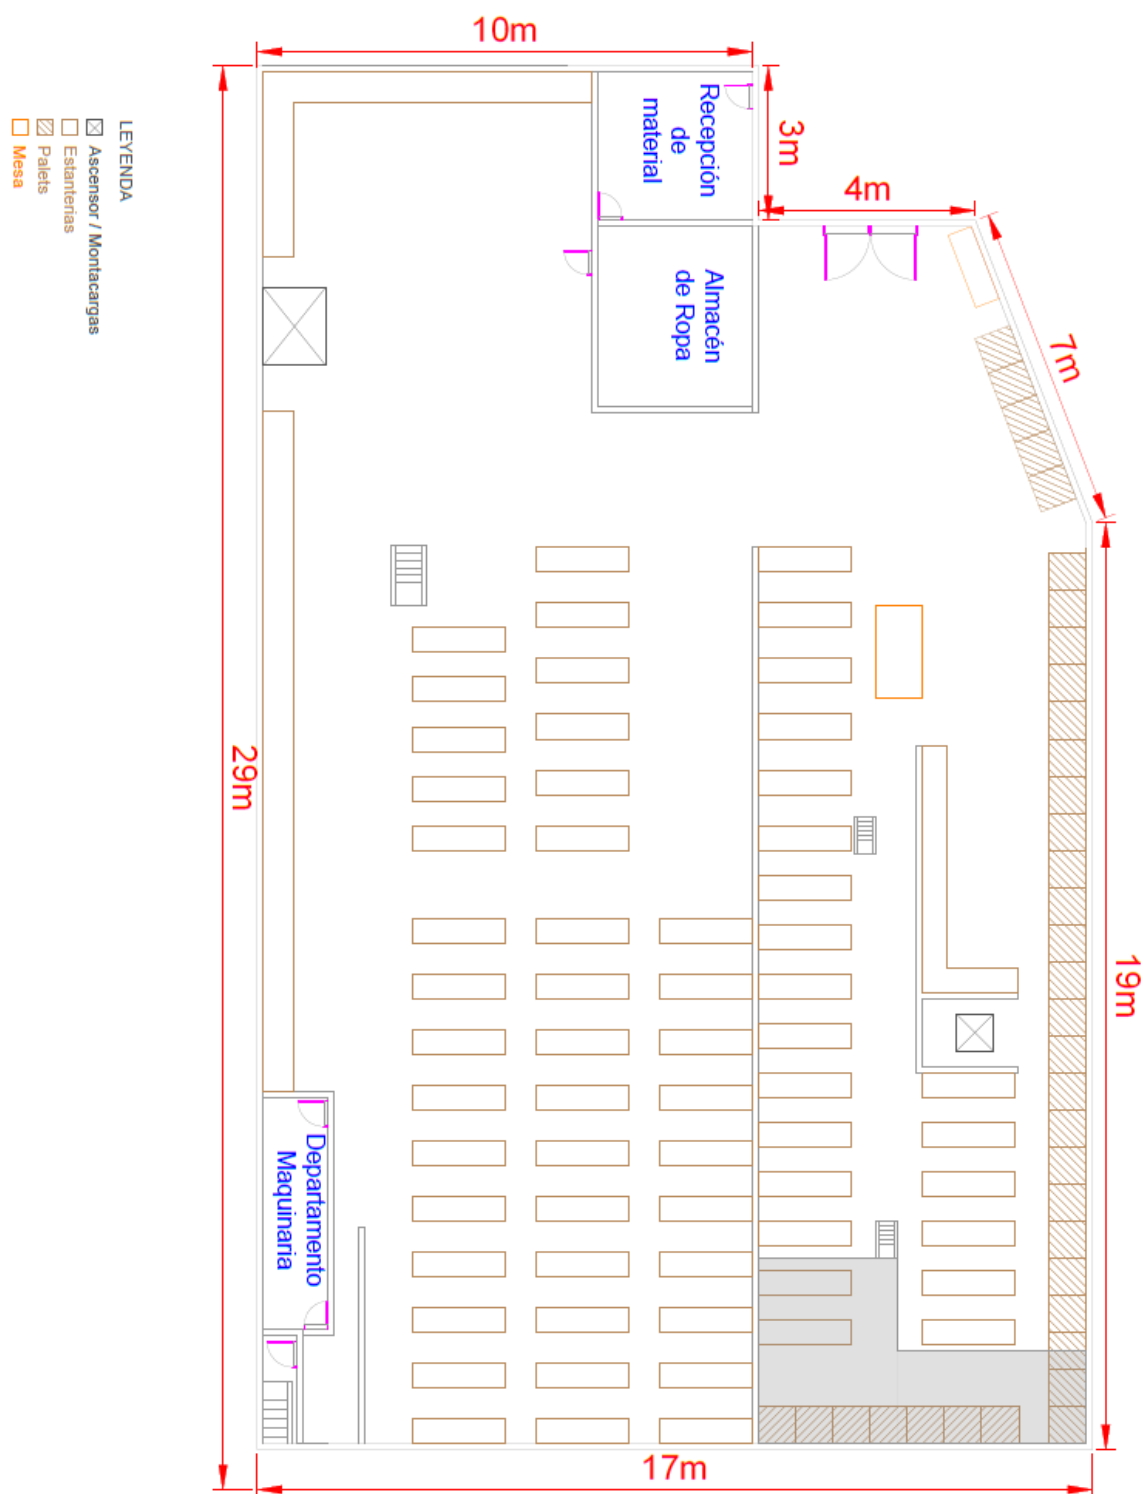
Imagen del plano de la segunda planta (Anexo D: P003)
